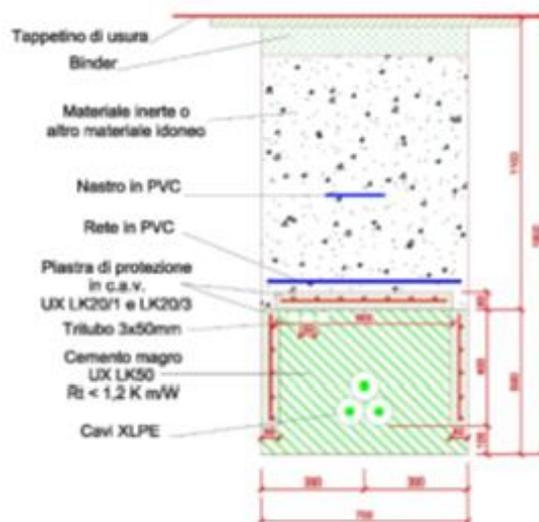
Esempio di rinterro con posa delle piastre di protezione e rete in PVC
